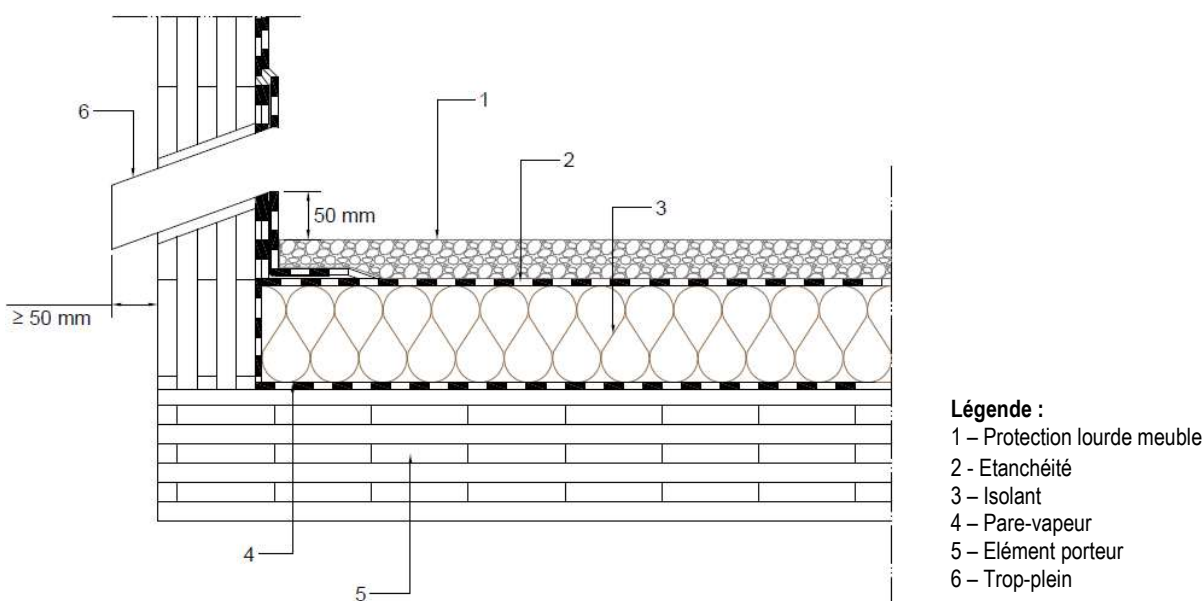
CLT - Positionnement altimétrique du trop-plein – toiture-terrasse étanchée avec protection lourde meuble
